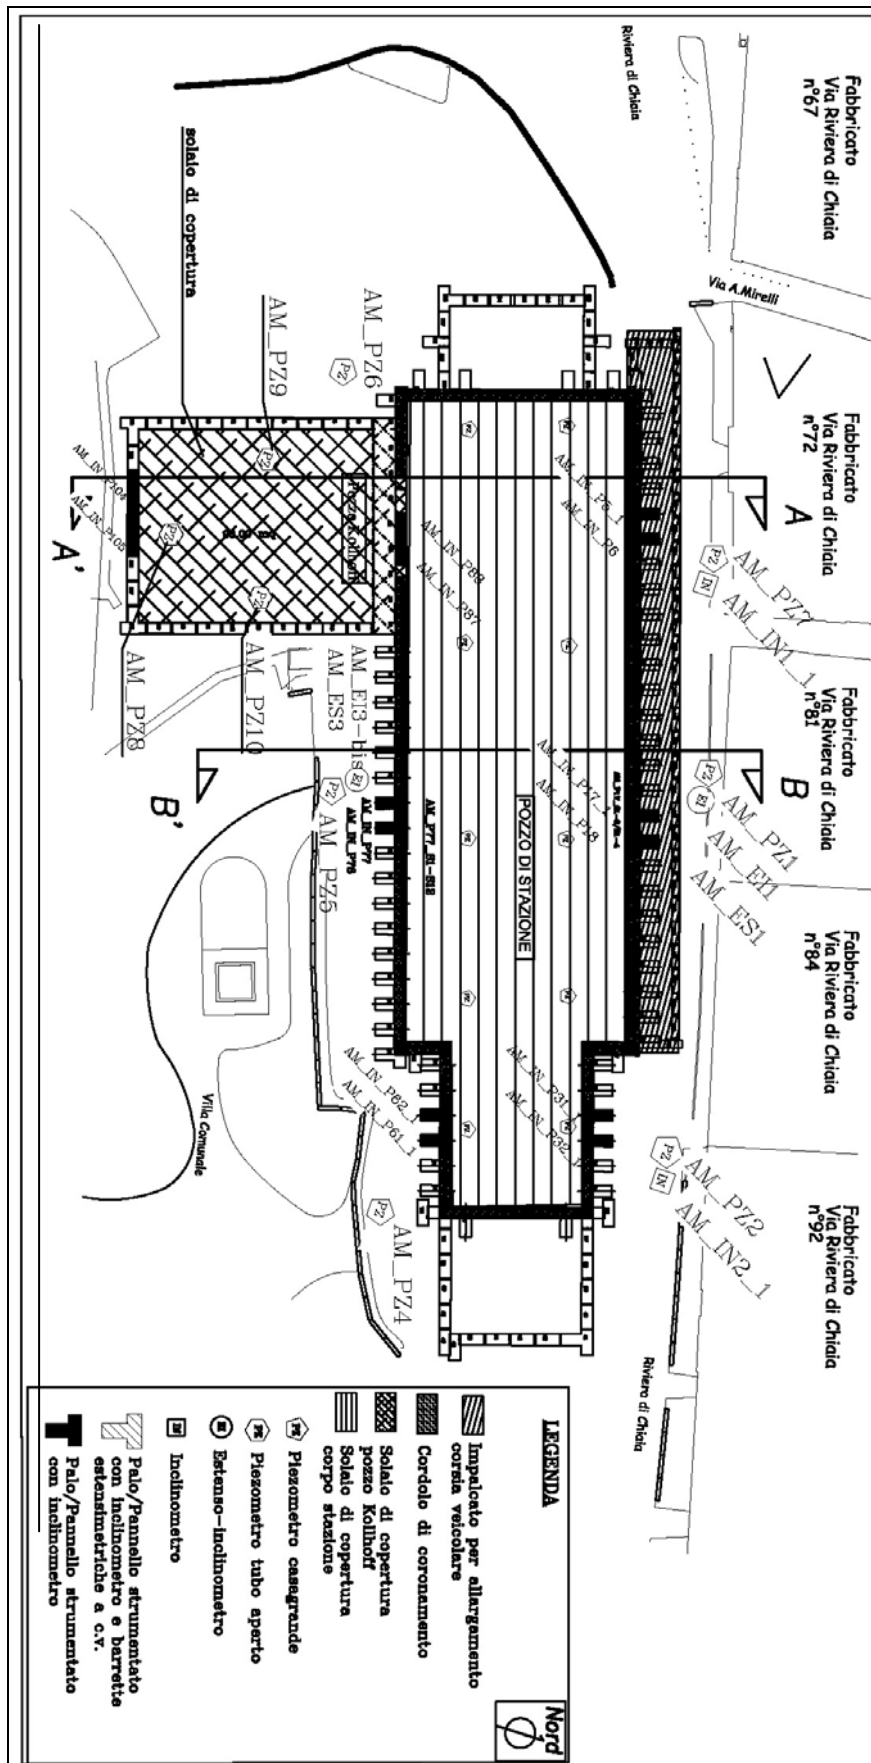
Planimetria pozzo stazione, raffigurante la suddivisione in aree di lavoro.
